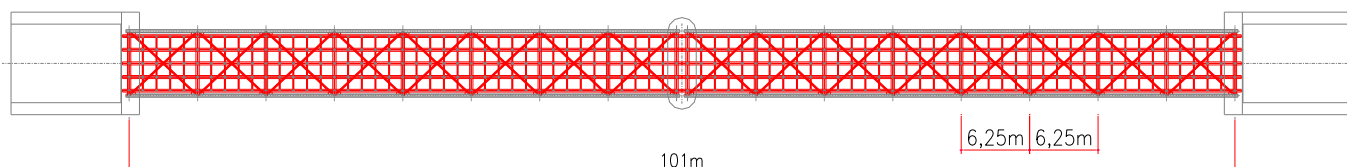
Planta da secção inferior do tabuleiro (Fonte: Estradas de Portugal)
